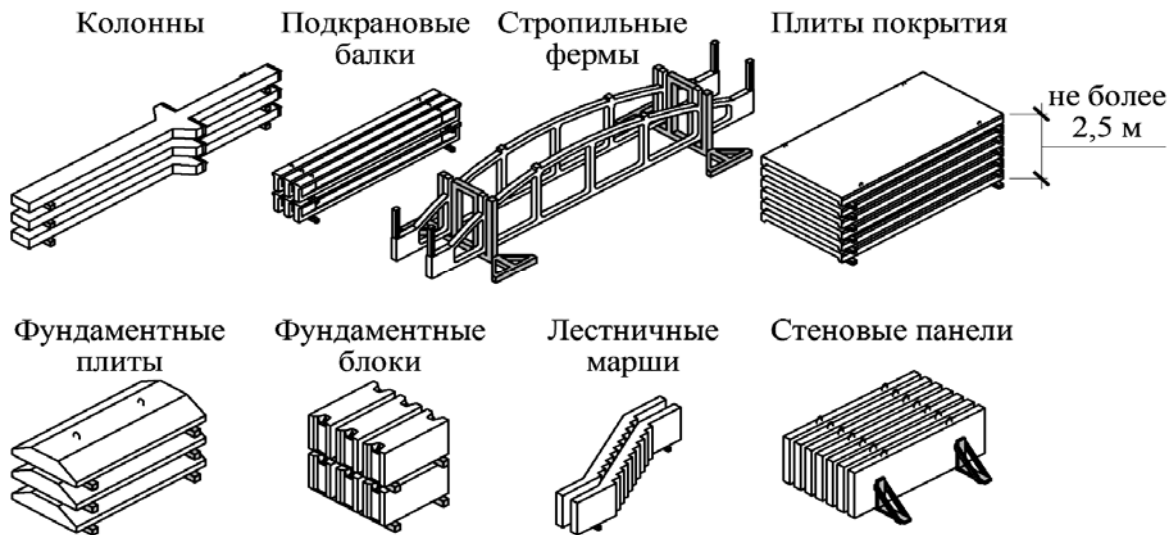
Примерная схема складирования железобетонных конструкций
